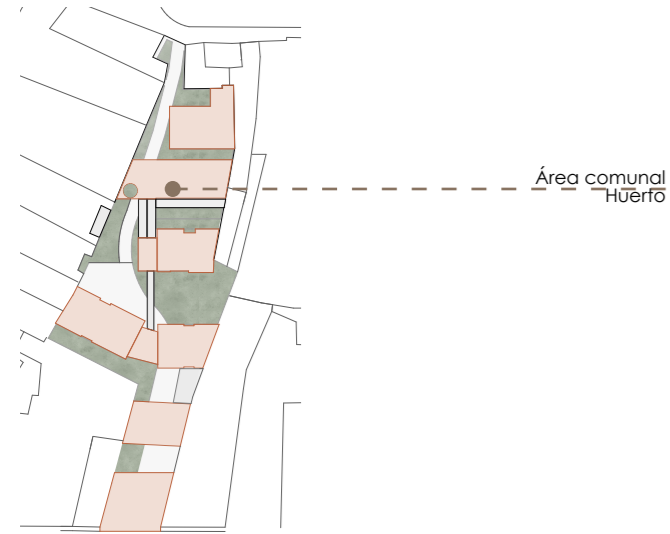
Planta baja tipo emplazamiento. Autoría propia
